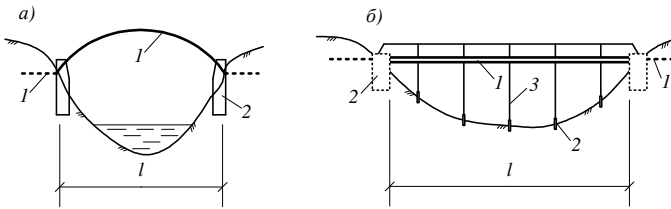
Схеми повітряних переходів газопроводів по фермах:
